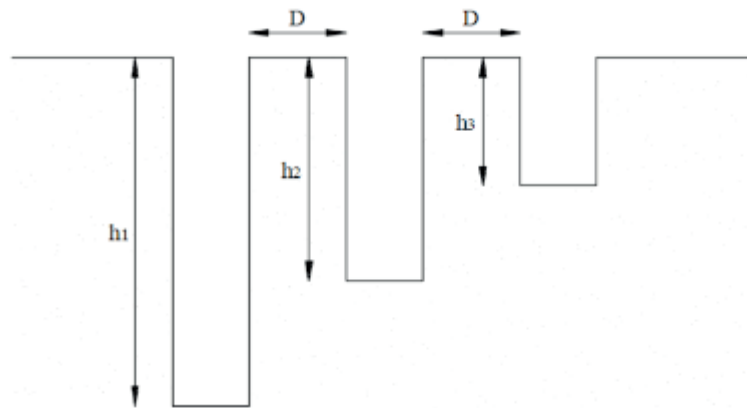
Disposição dos furos de sondagem para o ensaio Open end Hole
